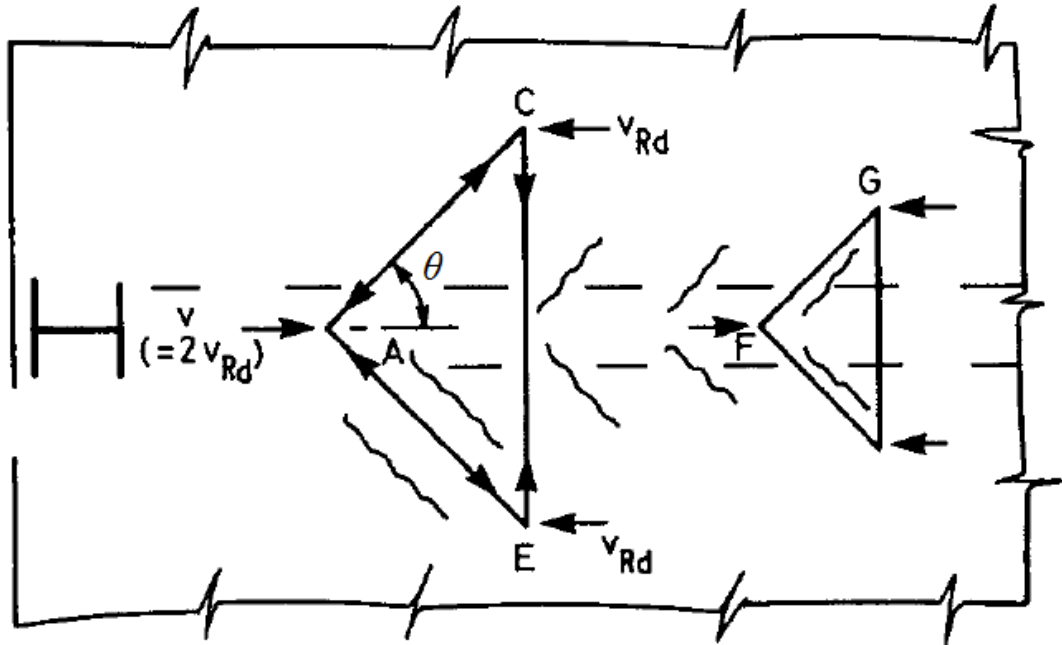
Фермова модель розрахунку поперечного армування
